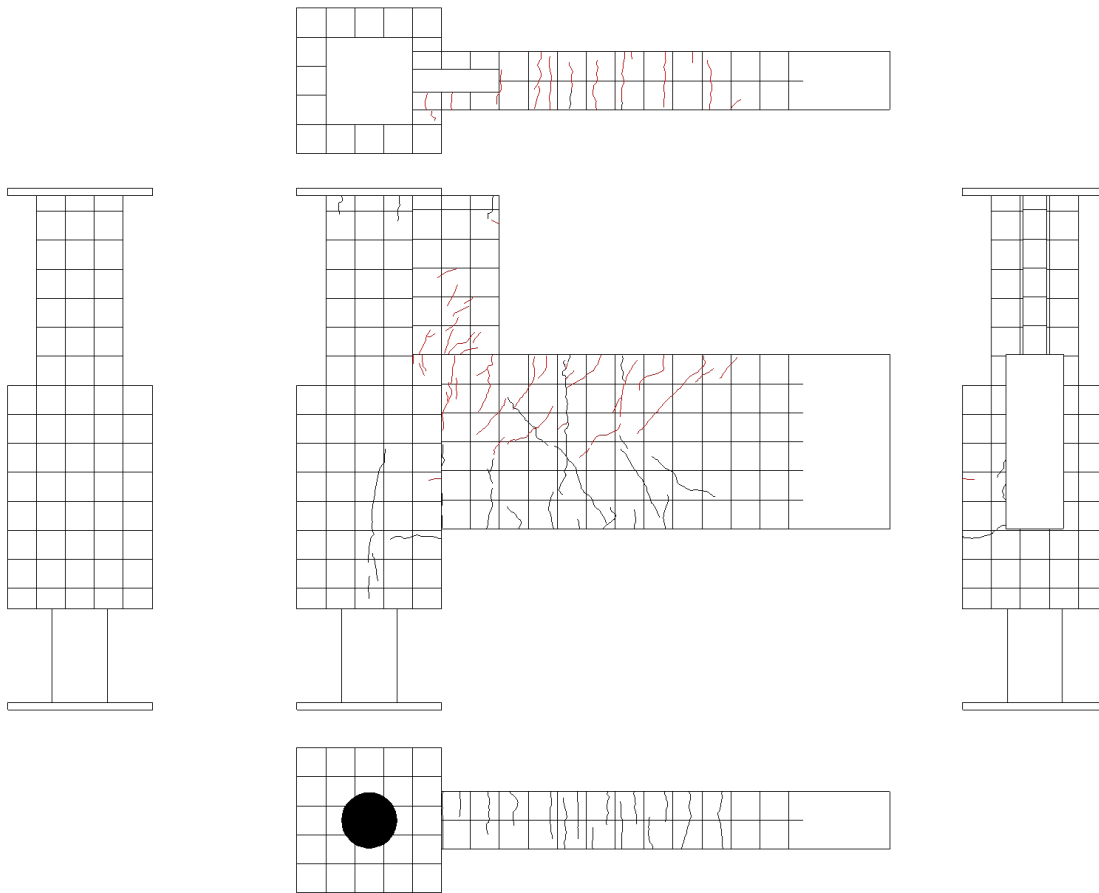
試験体 B-1 ひび割れ状況 (10Cycle)
